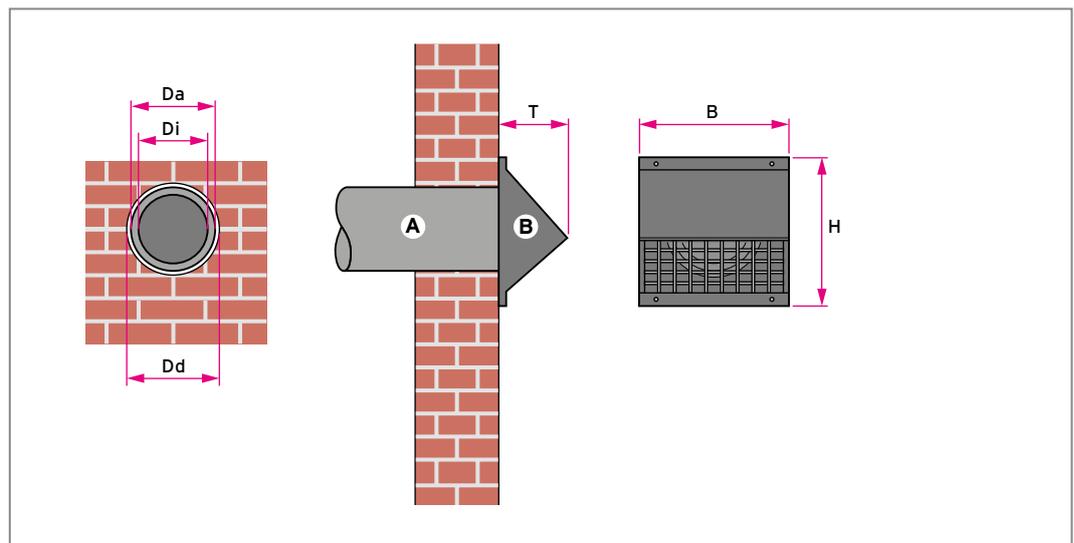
Fassadendurchführung mit dünnwandigem EPP Rohr
